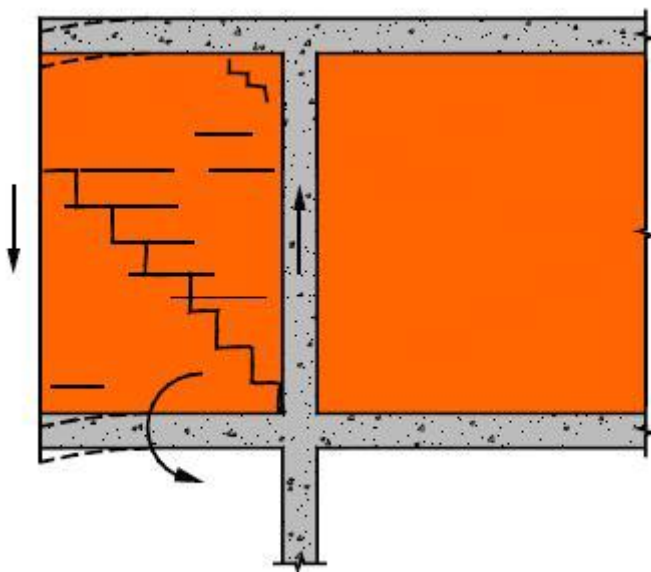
Fissuração característica de parede de alvenaria devido à deformação da laje em consola [4]
